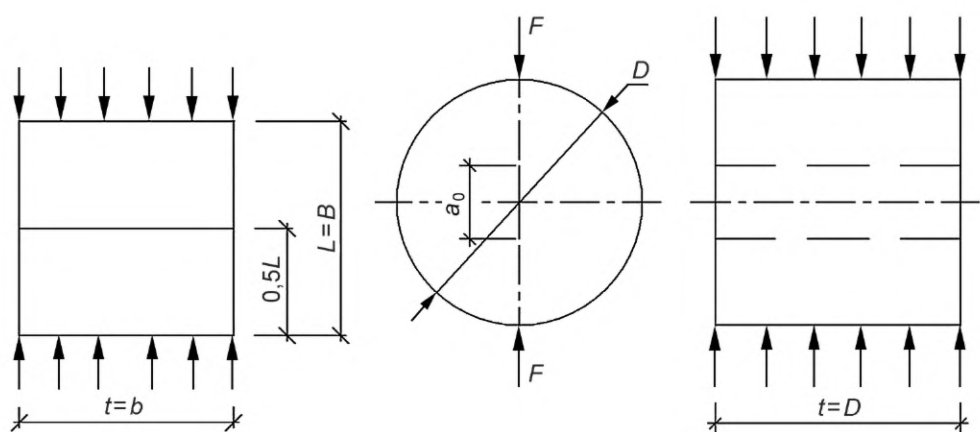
Образец типа 4 — цилиндр для испытаний на растяжение при раскалывании
